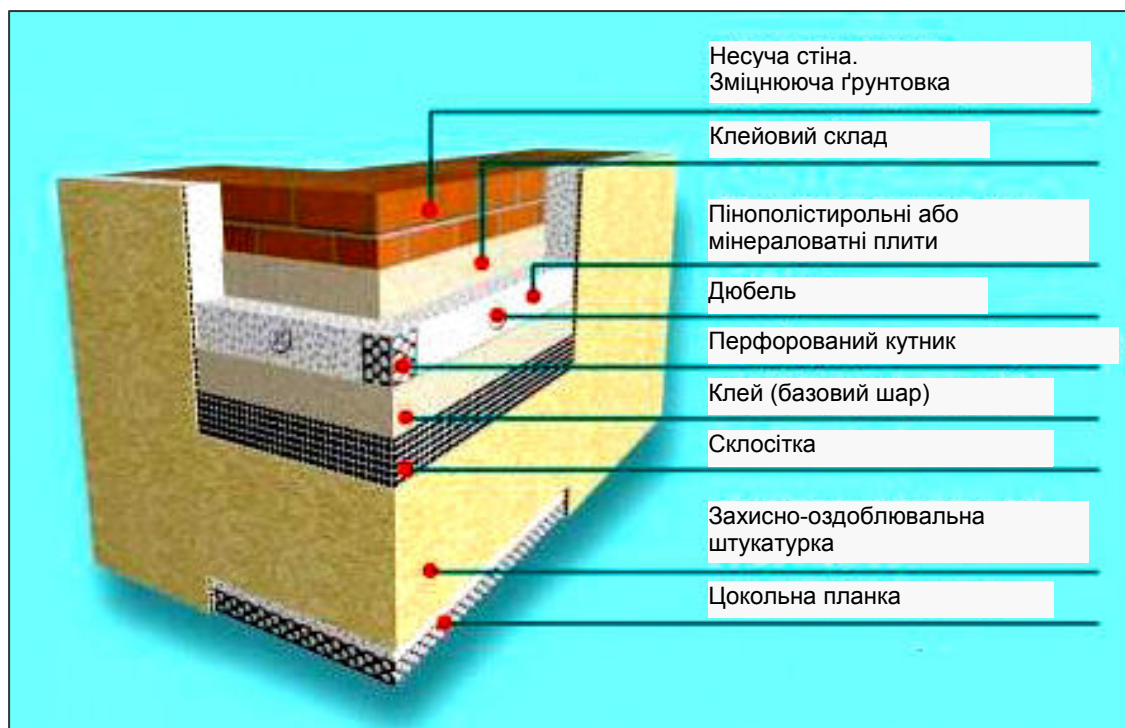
Загальний "пиріг" зовнішньої системи утеплення. Схема утеплення будинку пінопластом або мінераловатними плитами
